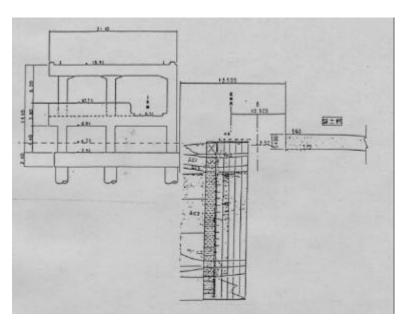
土質柱状図および施工箇所の概要図(代表断面)
